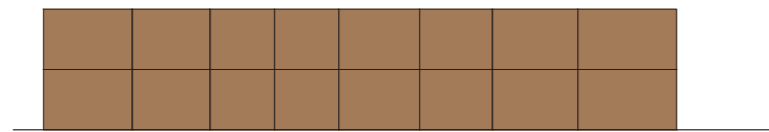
Levantamiento de tramo calle Honorato Vásquez
